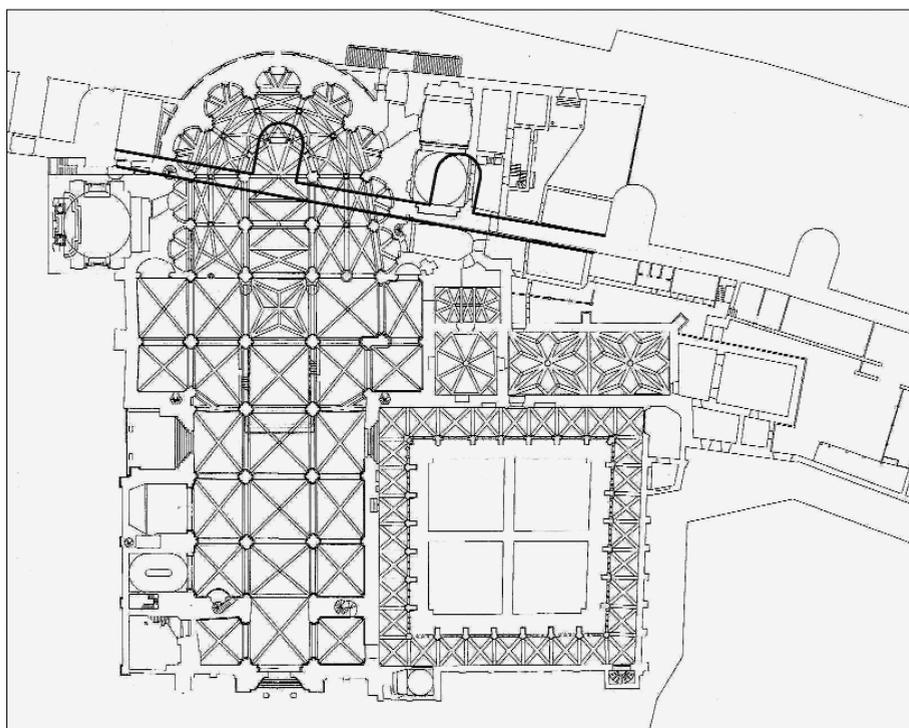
Hipotético trazado de la muralla con el torreón demolido para construir la capilla de San Segundo y uno en el espacio del presbiterio (n.º1).
